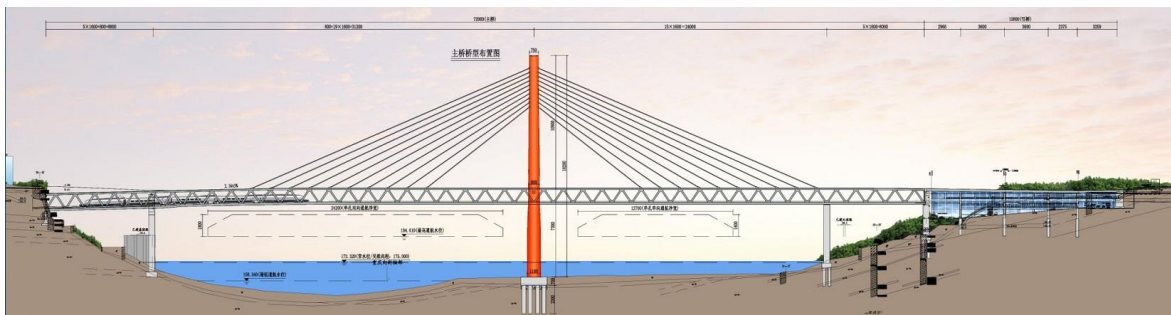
Alçado longitudinal da ponte Qianshimen, China [85]
